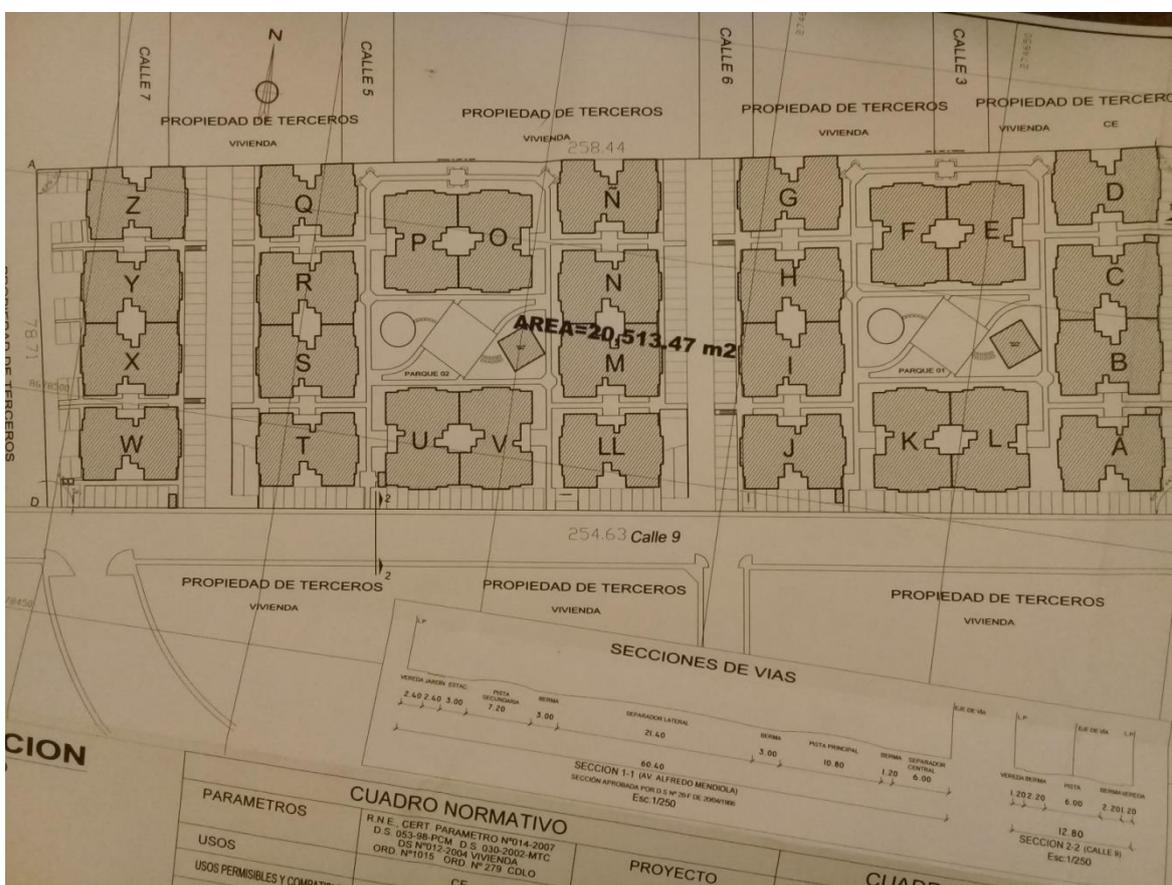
Planta General del proyecto aprobado del Condominio Las Torres de Los Olivos
